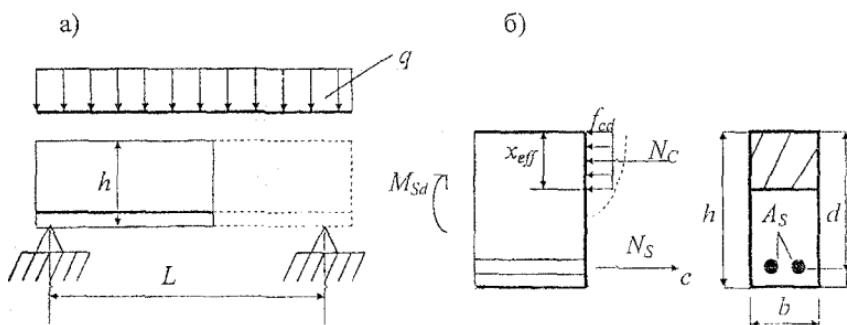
К расчету сечений с одиночной и двойной арматурой
